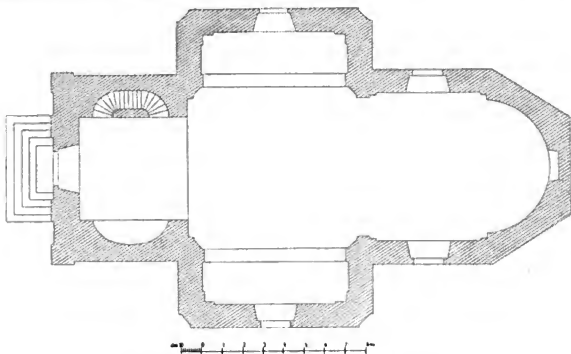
Rebfik. Grundriss der Kirche Sct. Peter und Paul.
